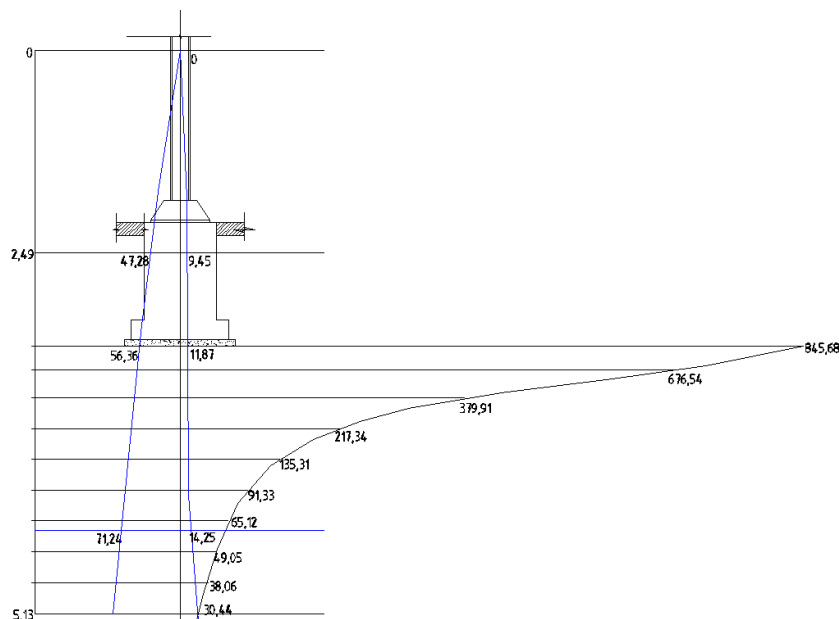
Определения осадки фундамента для крайней колонны
